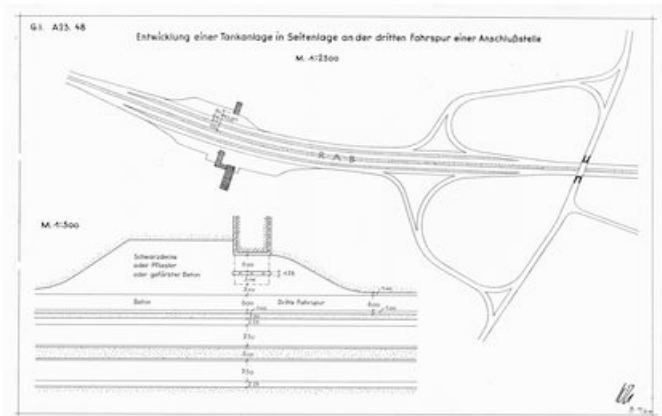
Formblatt zum Bau einer Tankanlage mit Anschlussstelle.
